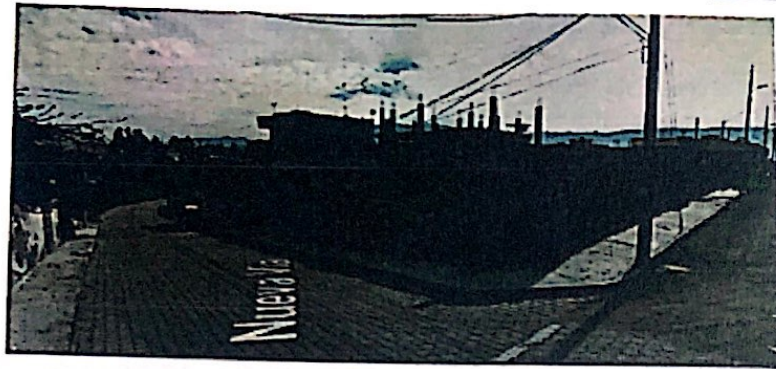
ACTUALMENTE CALLE GIRASOLES; QUEBRADA RELLENA
